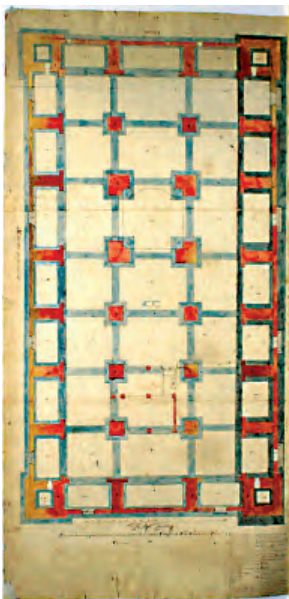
Archivo Capítular del Pilar, Planta de Felipe Sánchez. Foto: Javier Ibáñez Fernández.
